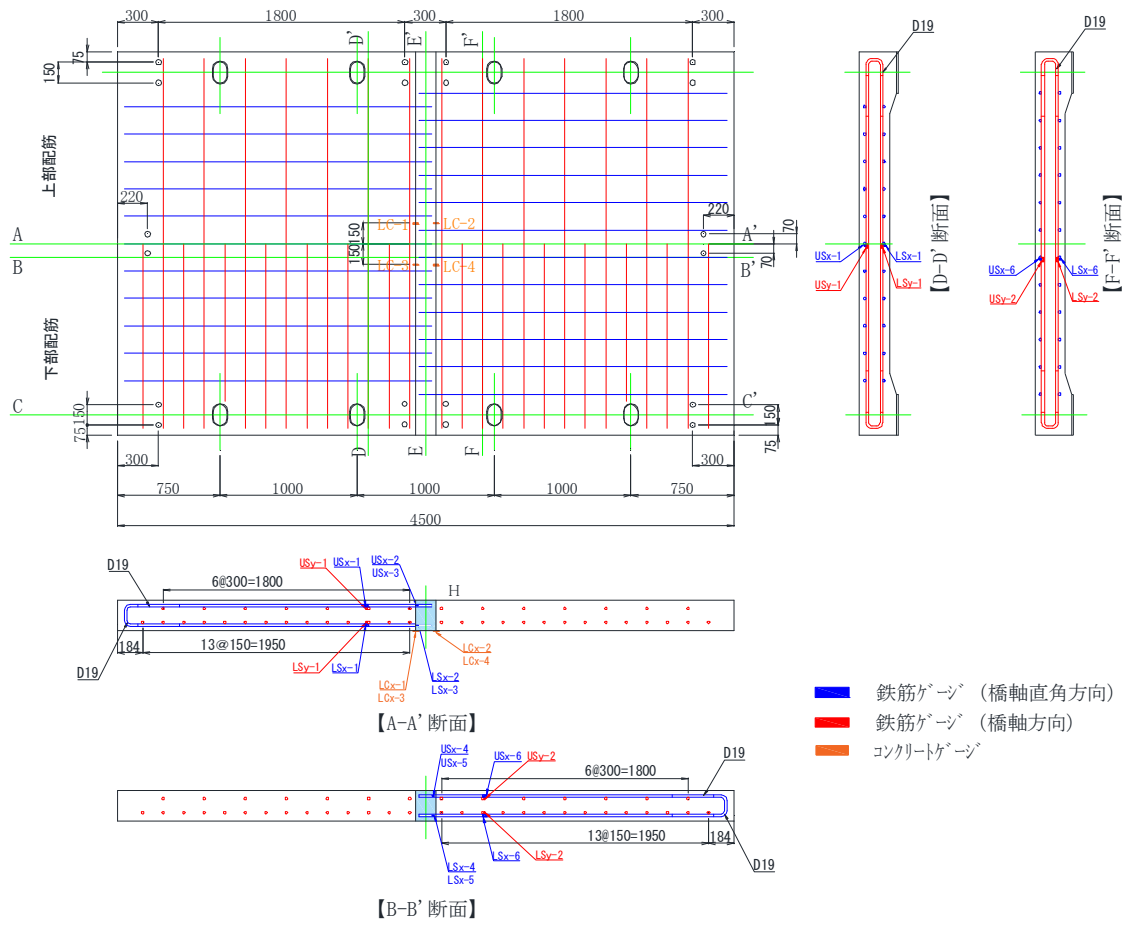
鉄筋およびコンクリートのひずみゲージ添付位置
